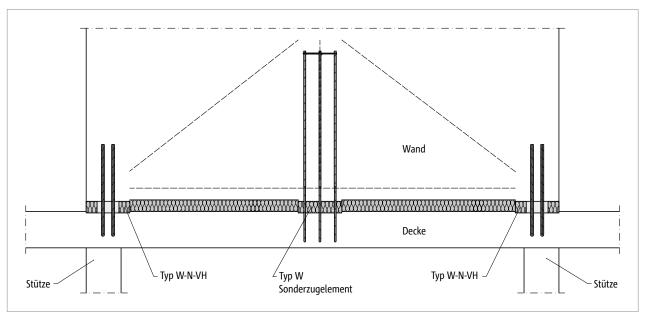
Schöck Sconnex® Typ W: Kombinierte Produktvarianten für den Anschluss eines wandartigen Trägers mit Deckenaufhängung
